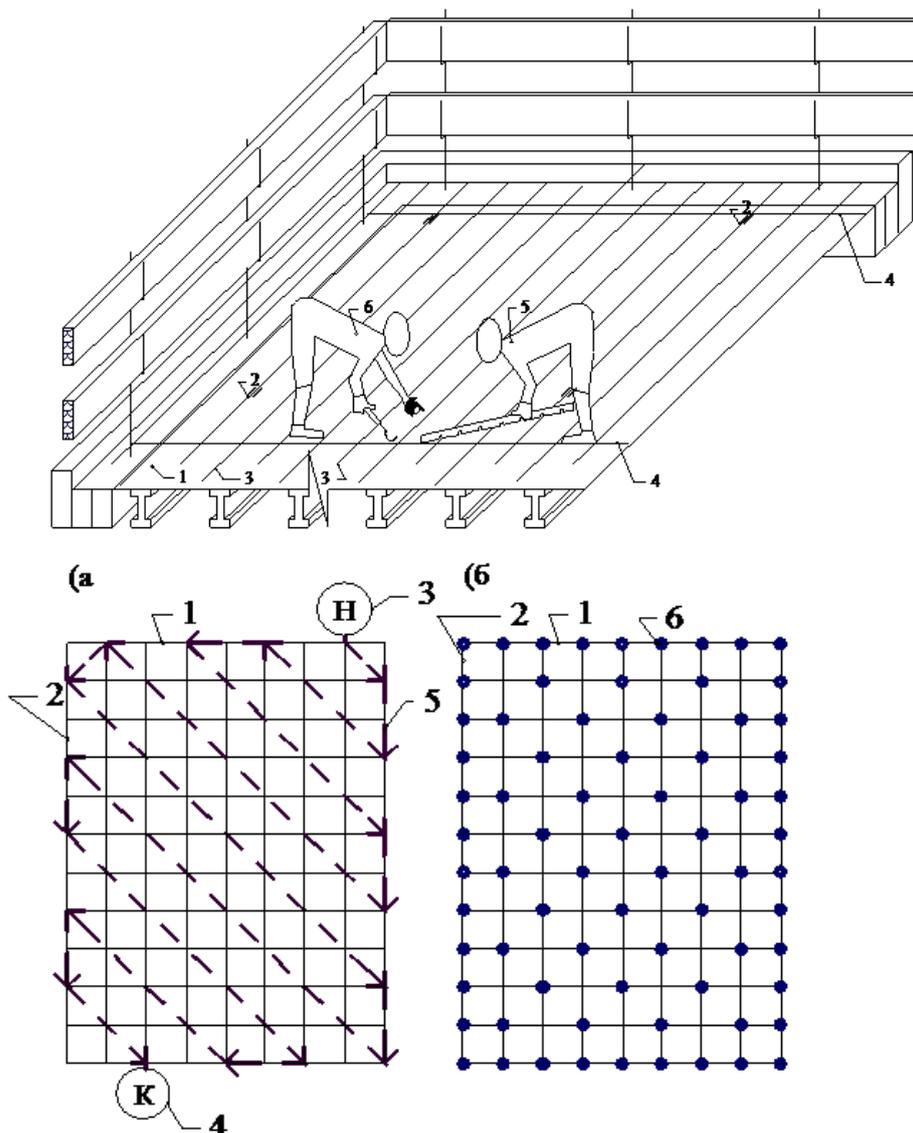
Порядок закрепления арматурных стержней вязальной проволокой: а) схема движения рабочего вяжущего пересечения стержней; б) схема закрепления стержней арматурной сетки: 1-поперечные стержни; 2 – продольные стержни; 3 – начало пути рабочего; 4 – окончание пути рабочего; 5-путь движения рабочего; 6 – пересечение арматурных стержней, закрепленное вязальной проволокой
